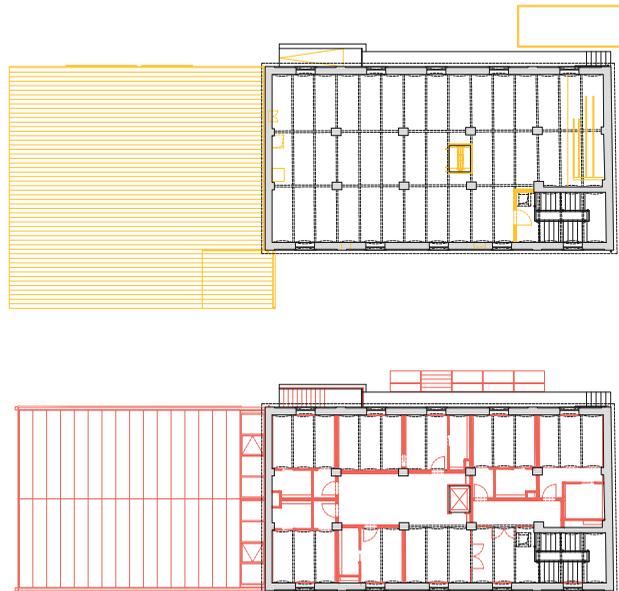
Grundriss 2. Obergeschoß, Abbruch / Neubau, M 1:500
